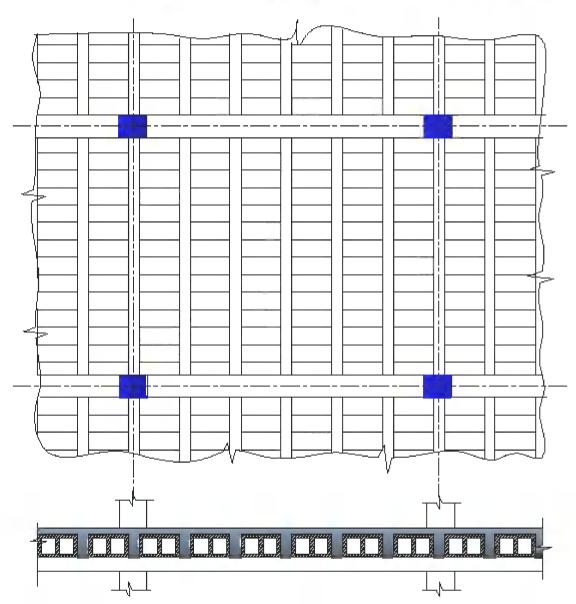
بلاطة ذات أعصاب في الاتجاهين - (Waffle) عصاب في الاتجاهين الاتجاهين - (14-9)
